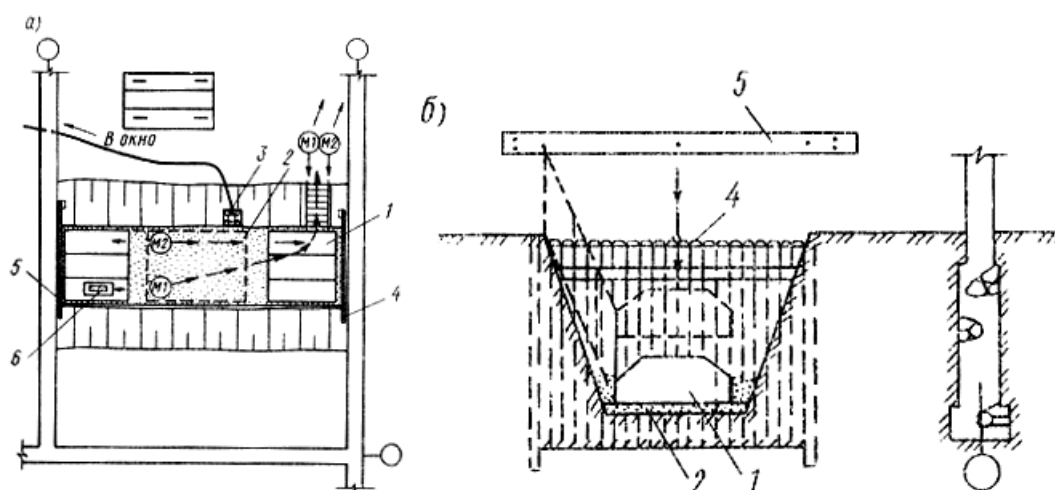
Схема организации монтажа железобетонных фундаментных плит
